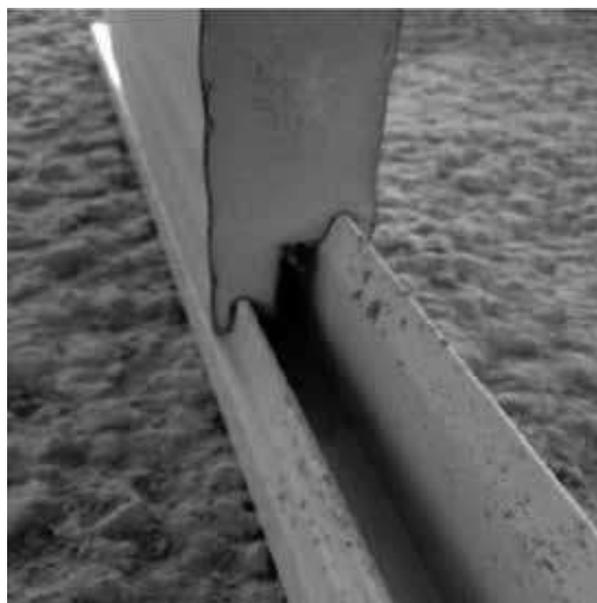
Detalhe do perfil guia no piso e do encaixe com o painel metálico isolante. (DÂNICA, 2013b)
